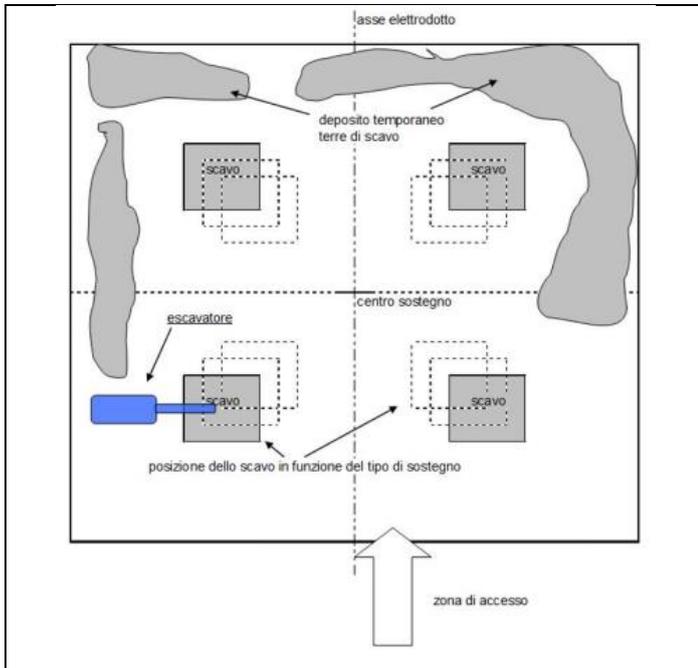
Planimetria dell'area di sostegno (scavo di fondazione) – Tipologico
